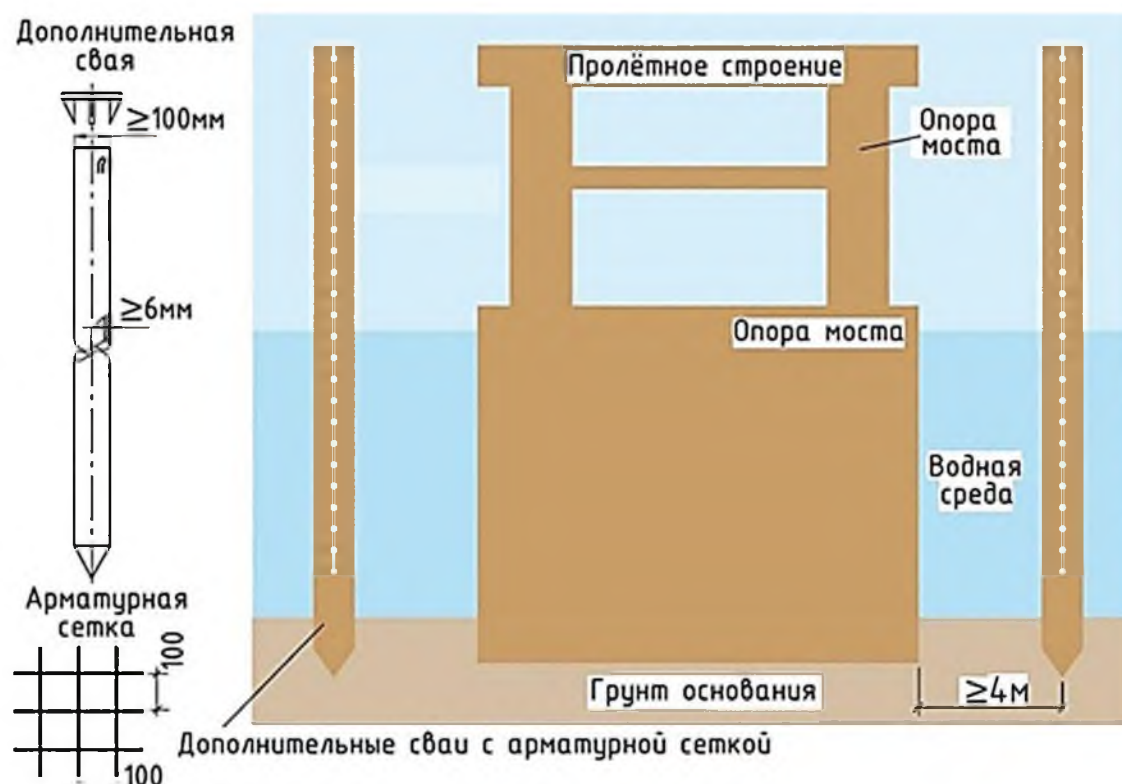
Вариант схемы размещения в разрезе дополнительных свай, соединённых с арматурной сеткой, для защиты опор Крымского моста
